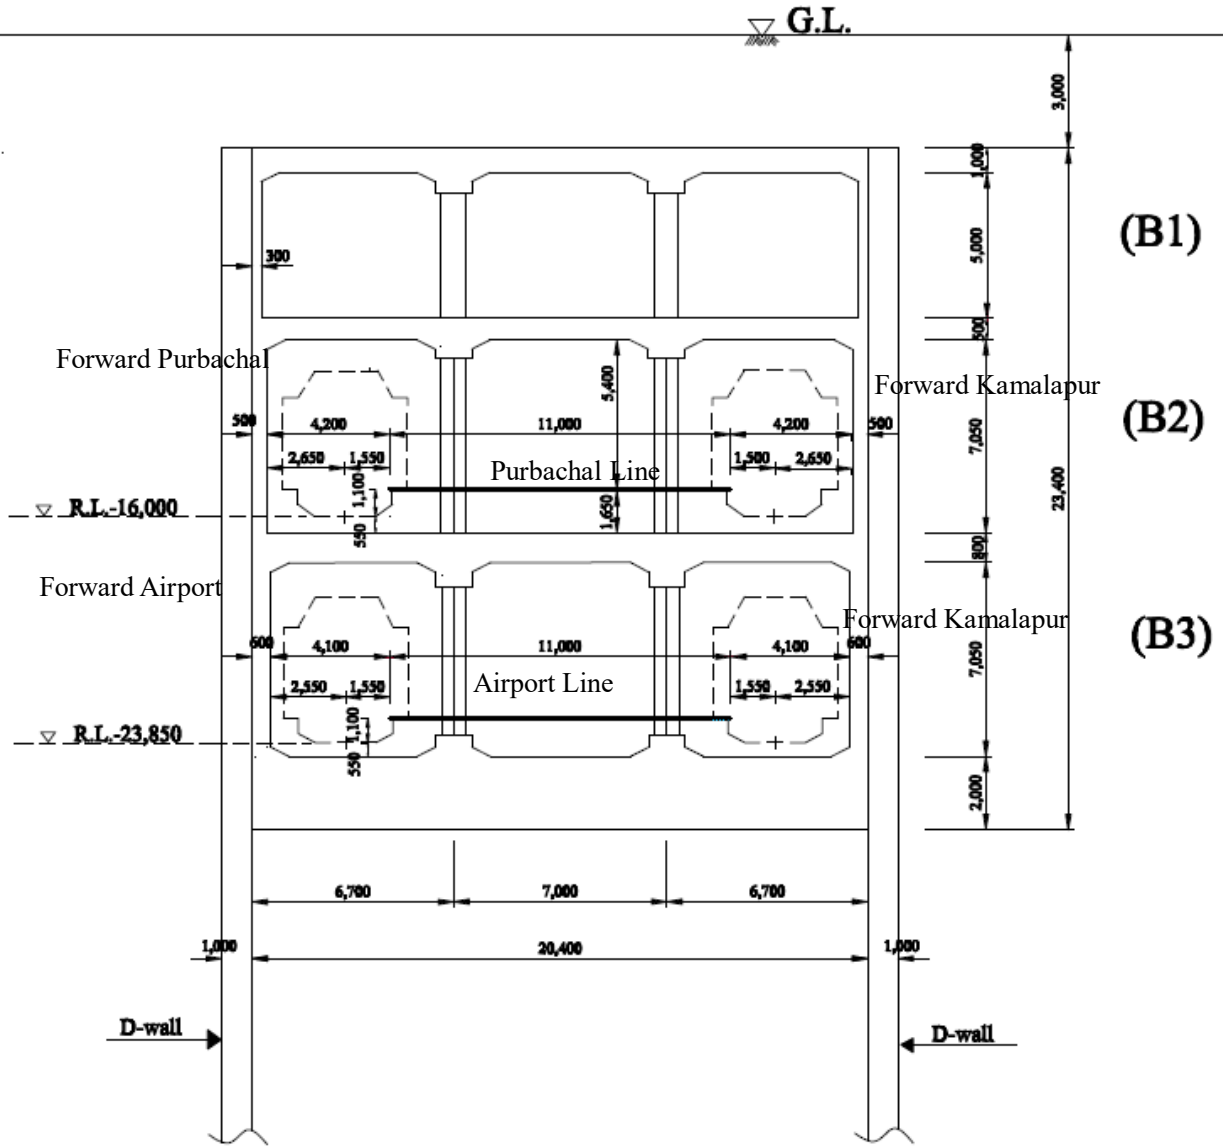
Notun Bazar 駅 平縦断面図 (C-C Section)
